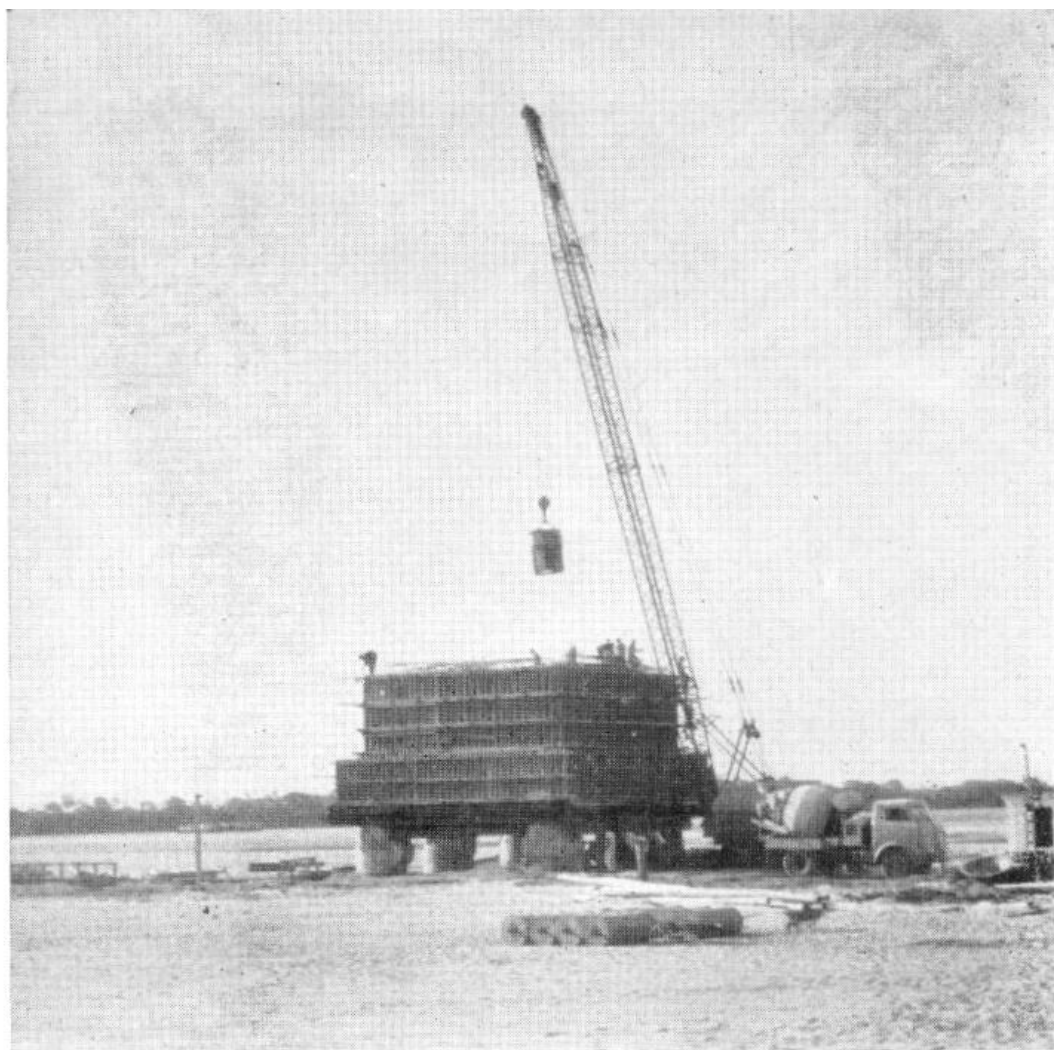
Vista parcial do coneteiro de confecção das vigas de 45 m.
